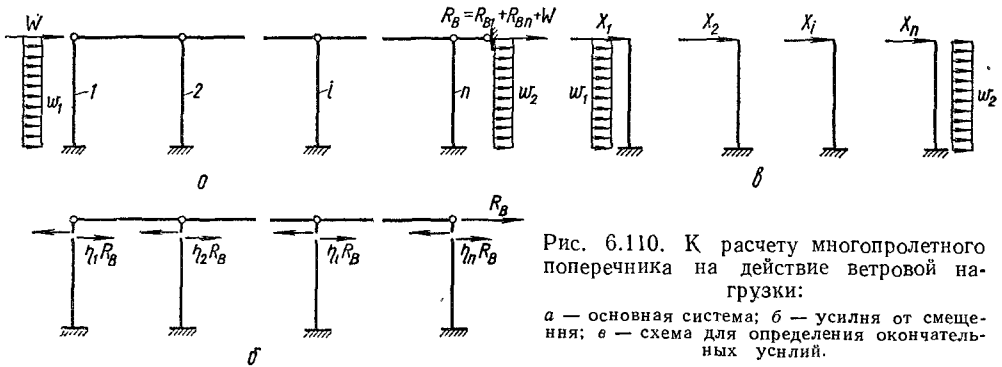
К расчету многопролетного поперечника на действие ветровой нагрузки:
